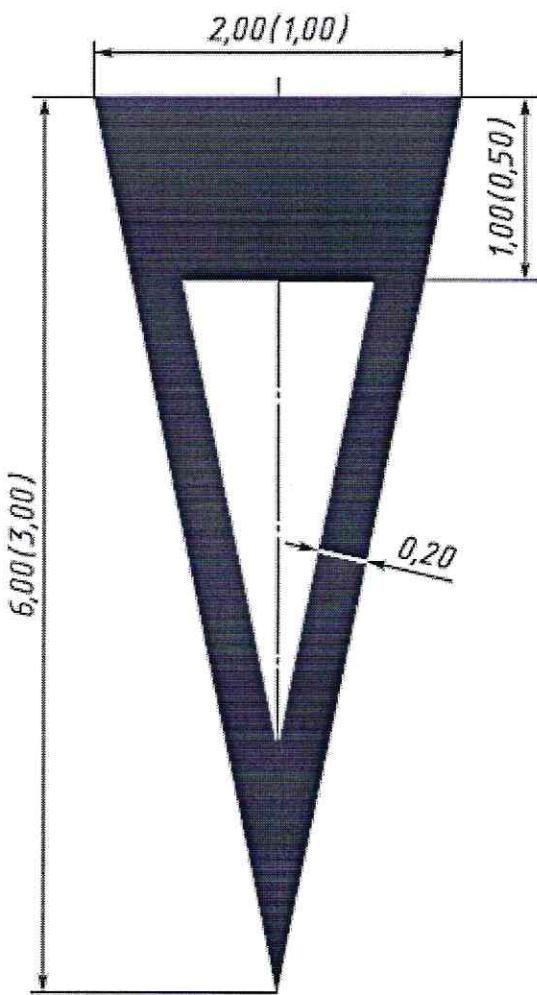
Форма, расположение и размеры стрел разметки типа 1.19
